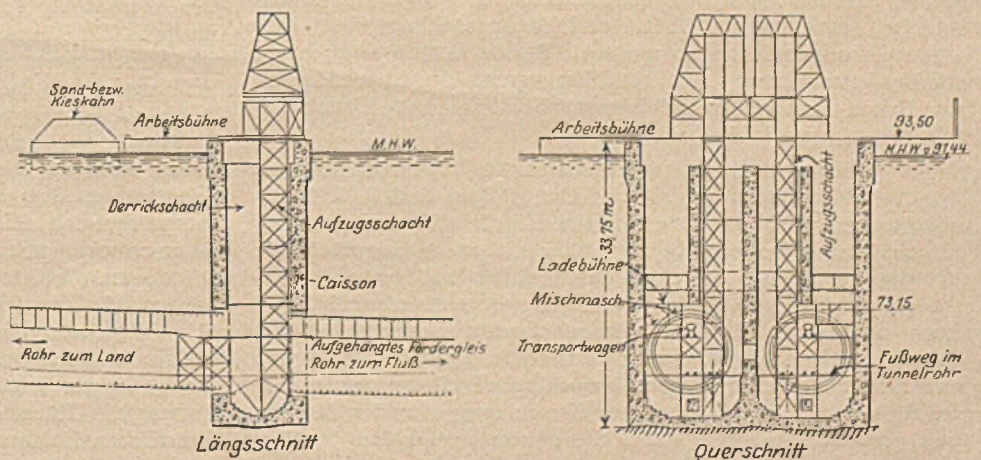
Materialzufuhr durch die Ventilationstürme.
